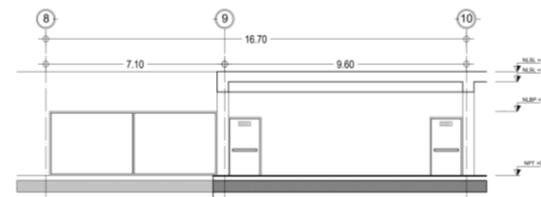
Fachada norte, Laboratorio de Restauración del MNA. Elaboración propia.
